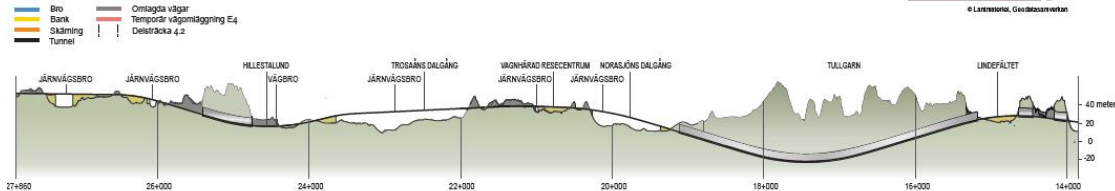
Översikt över planerad järnvägsanläggning Gerstabergr-Långsjön.
